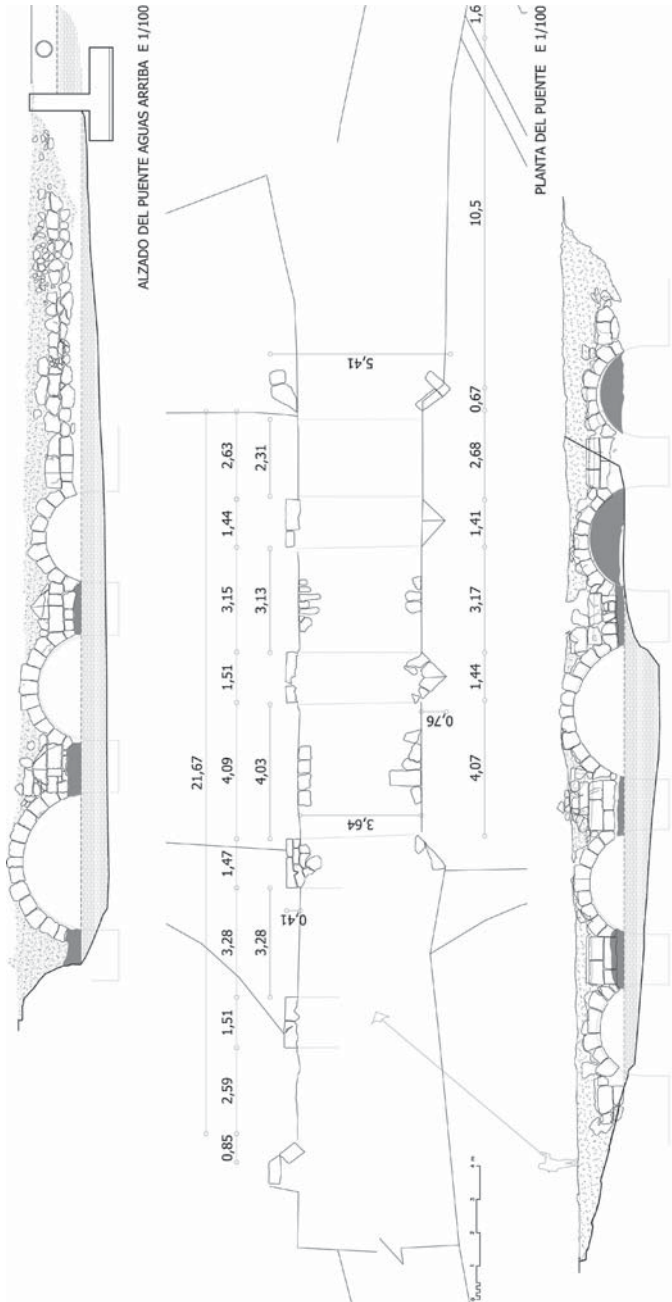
Planta y alzados del puente. Proyecto de restauración.
